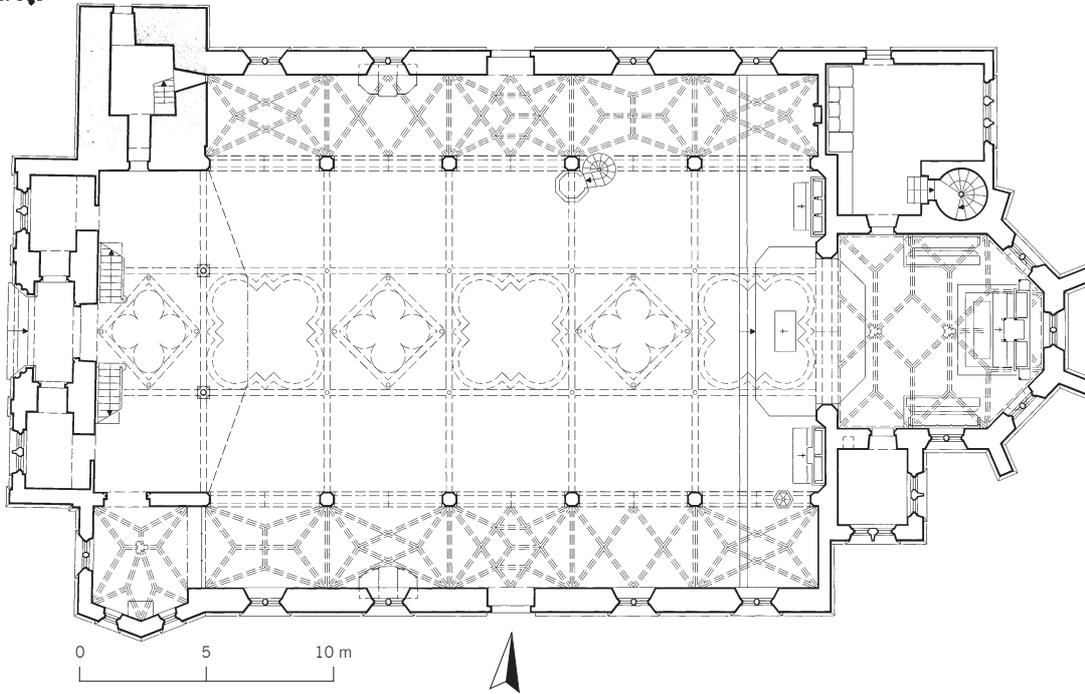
Oberägeri, Pfarrkirche St. Peter und Paul. Grundriss 1:300.
